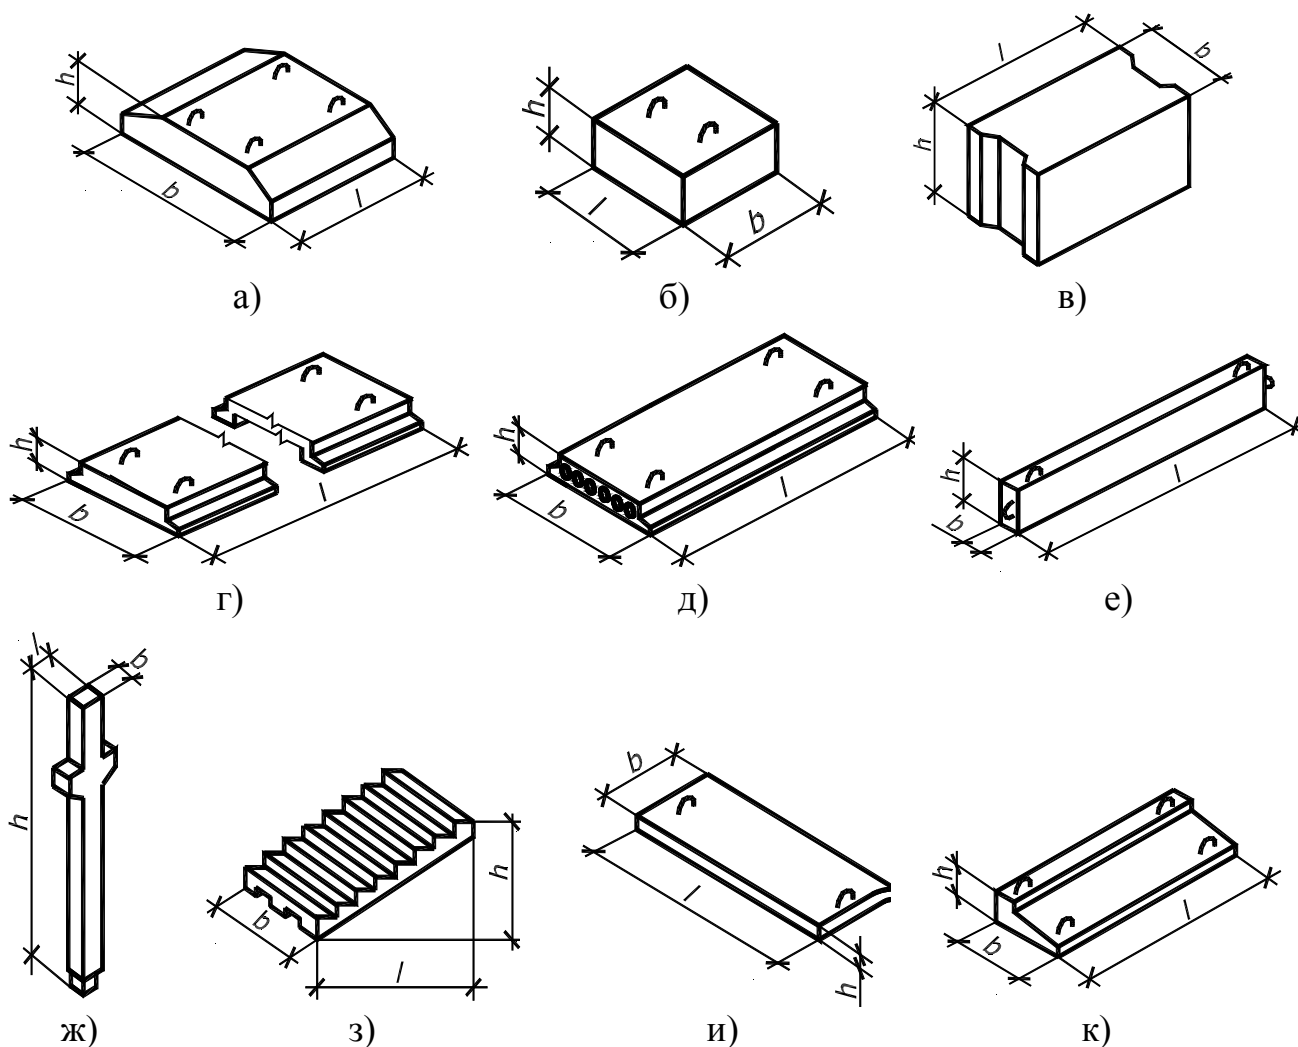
Типовые железобетонные изделия: а) фундаментный блок; б), в) стеновые блоки подвала; г) настил перекрытия; д) плита перекрытия с круглыми отверстиями; е) ригель или прогон; ж) колонна; з) лестничный марш; и) мозаичная проступь; к) балконная плита
